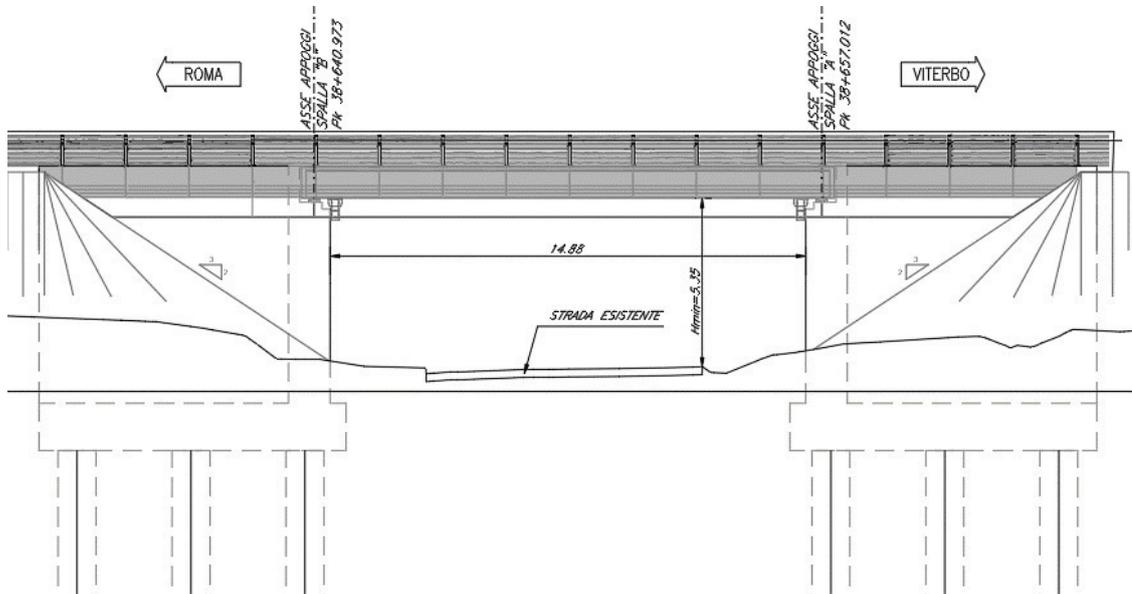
Ponte ferroviario VI01 al km 38+650: prospetto
